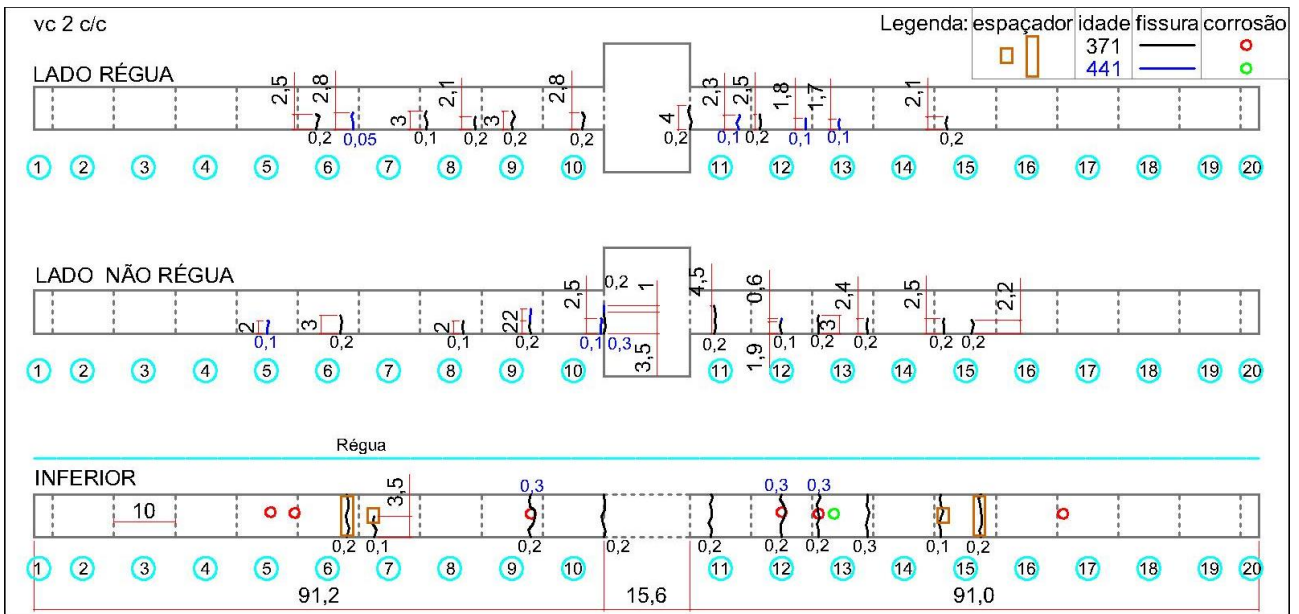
Mapa das fissuras na viga vc 2 c/c
